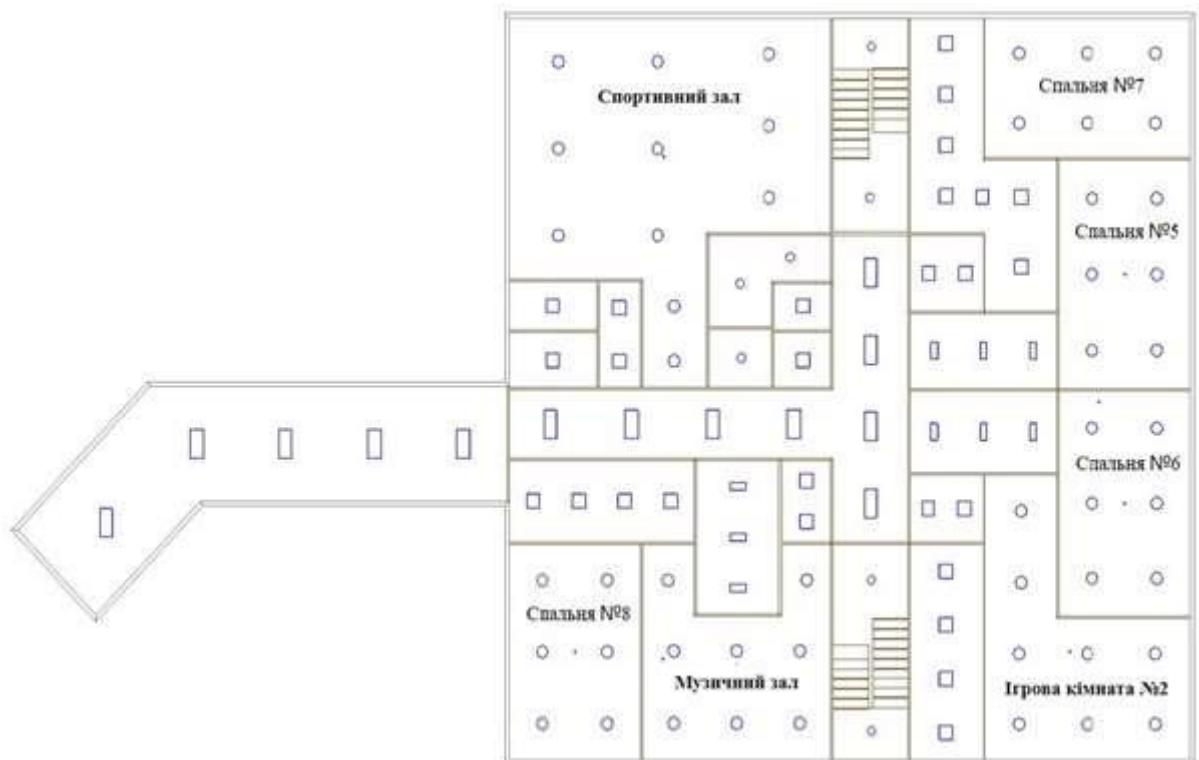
План роцташування світильників у другій половині будівлі садочка.
